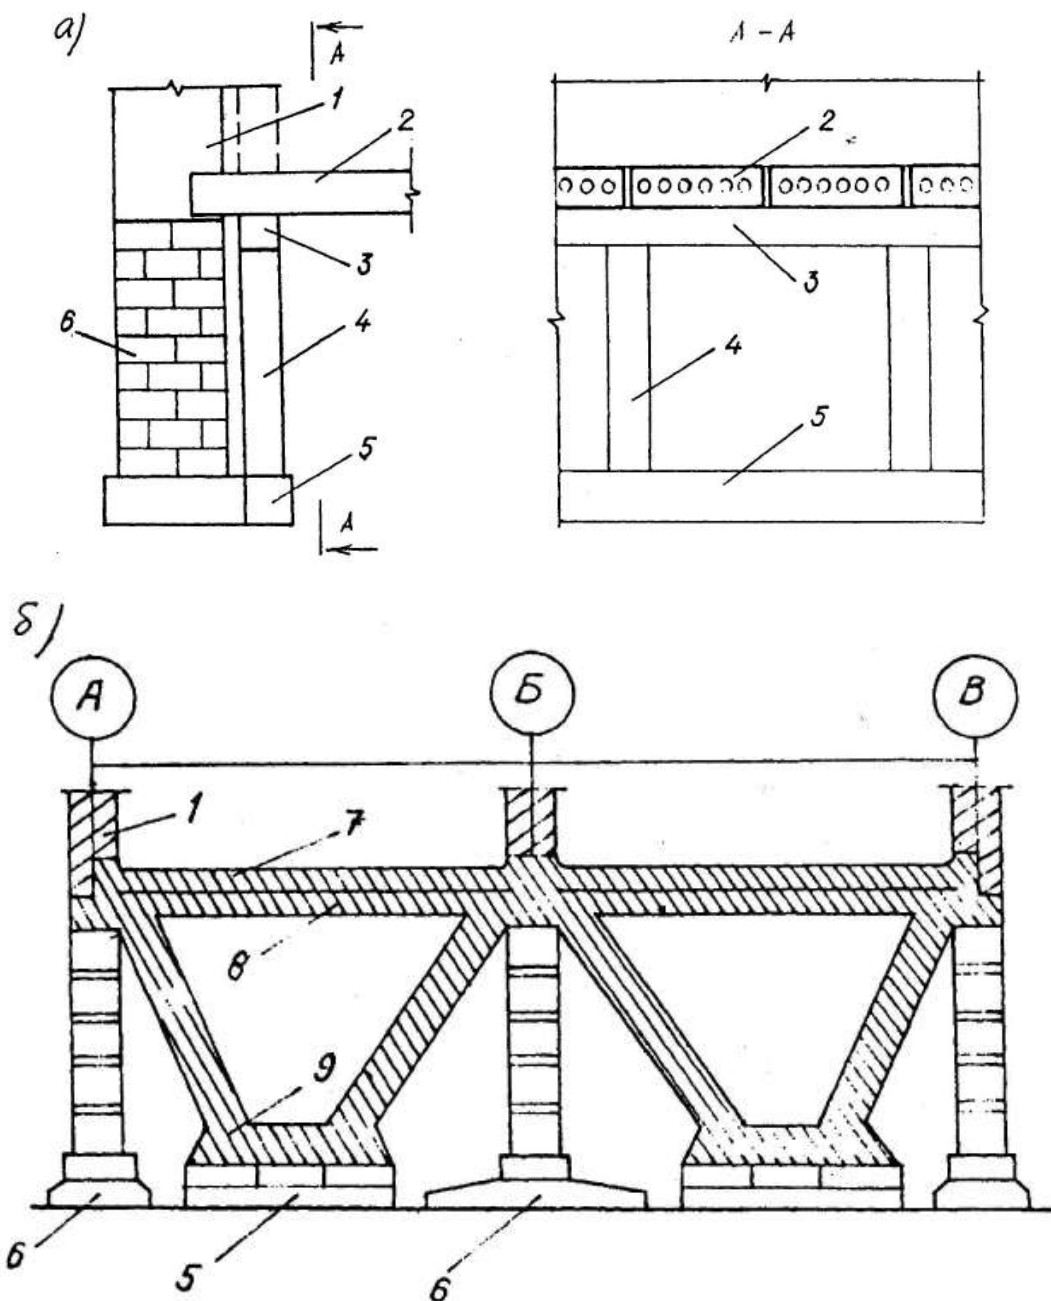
Підсилення тілу фундаменту підведенням додаткових опор під плити над підвалом:
